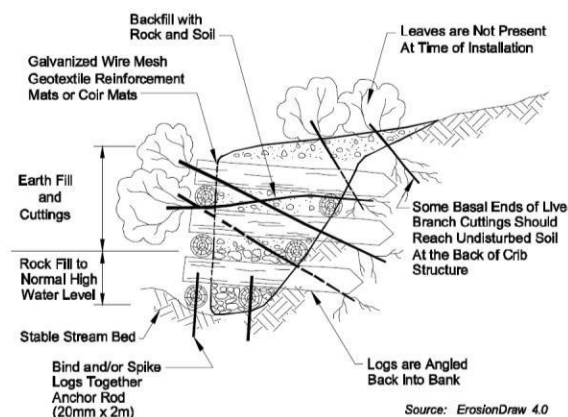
Muro de suporte vivo em detalhe (Fonte: ErosionDraw 4.0)
